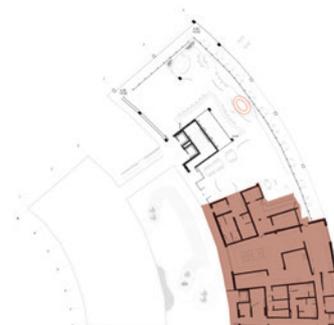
Planta Piso 3 | Localização da Área Técnica do Restaurante
